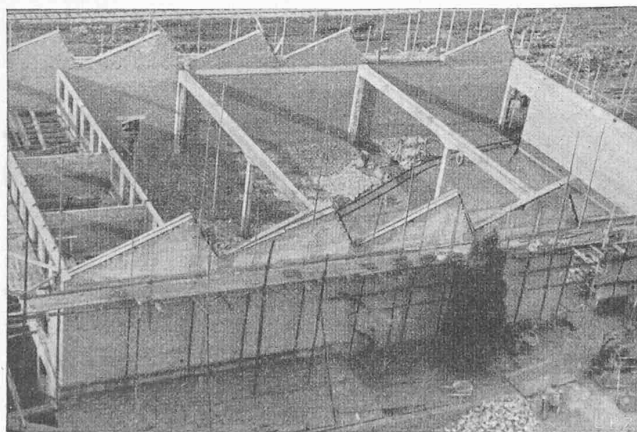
Bau von 1942, Eisenbetonkonstruktion
